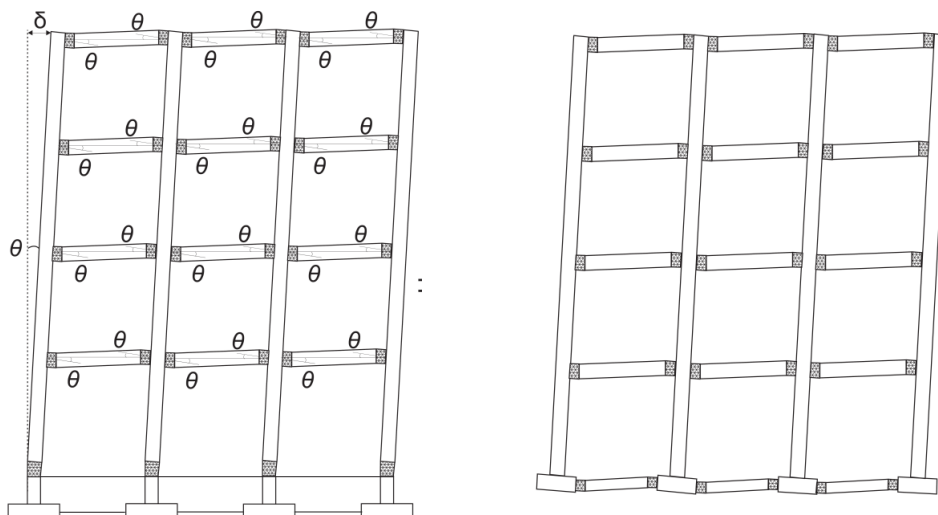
Mecanismo pilar forte/viga fraca (Fardis, 2008)
